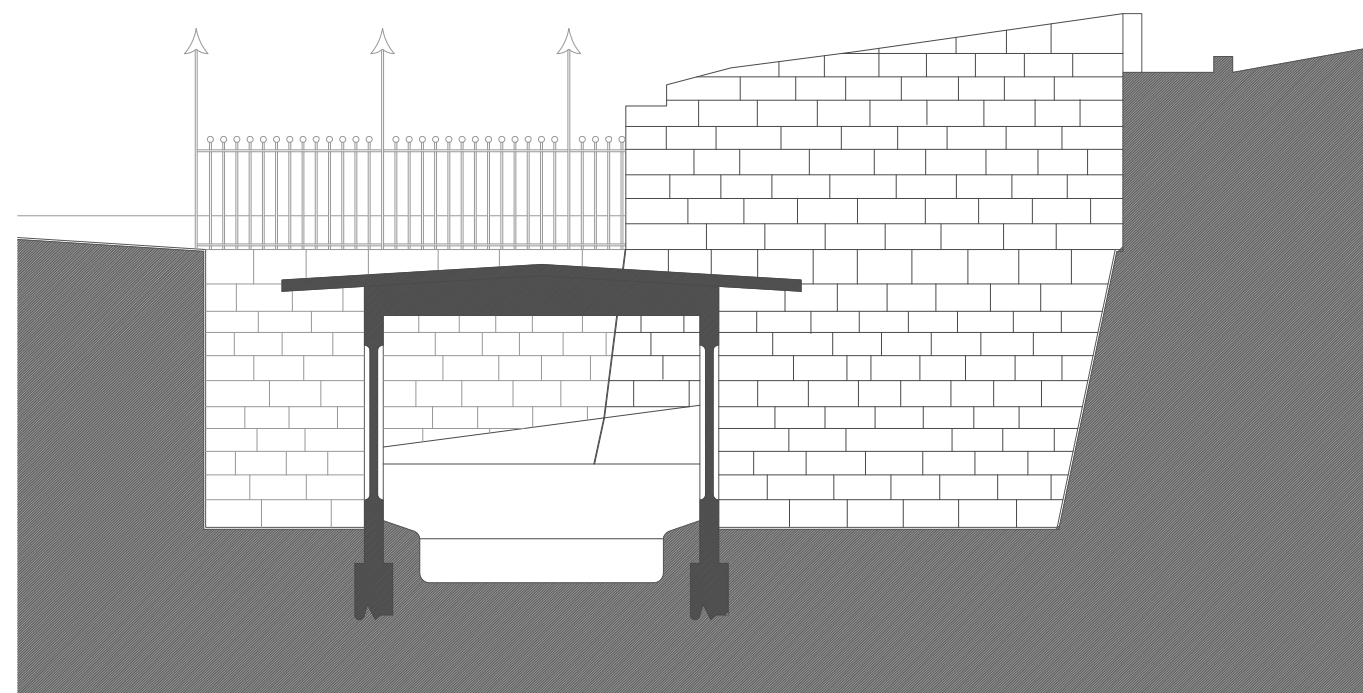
Lavadouro da Prêsa Velha, cobertura em cimento armado - Corte - esc.1/200
